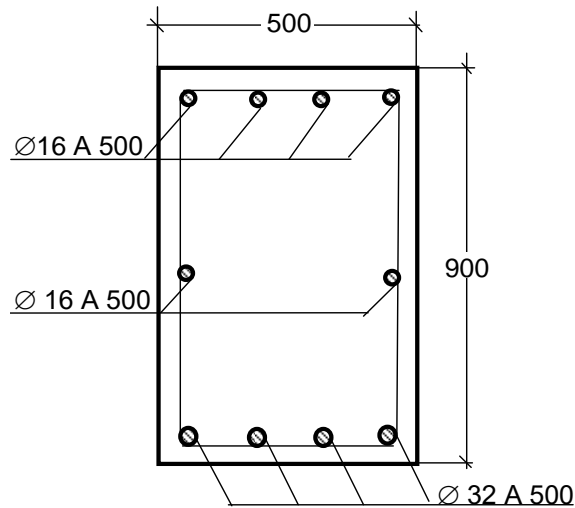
Параметри перерізу та схема армування залізобетонної балки
